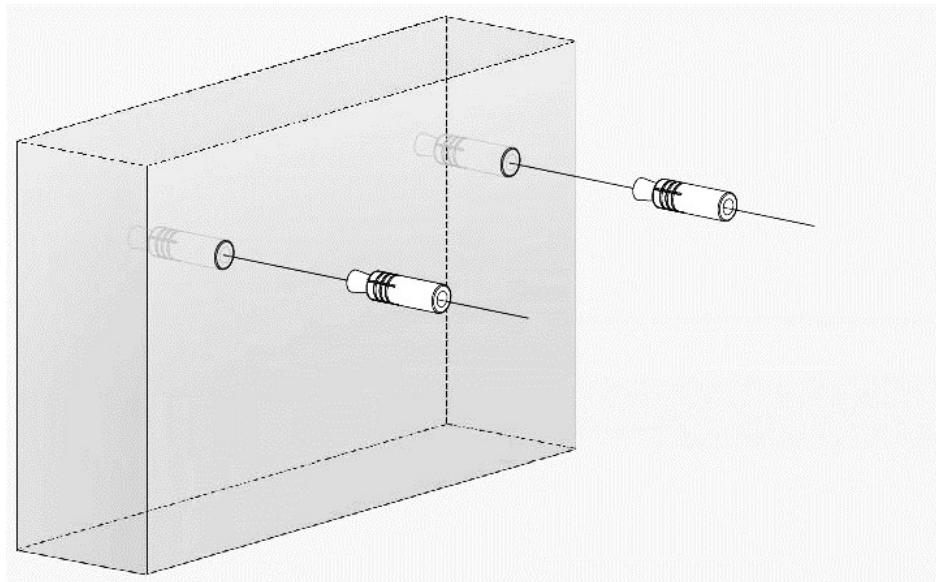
Montageschema für Wandanker (Edelstahl)
